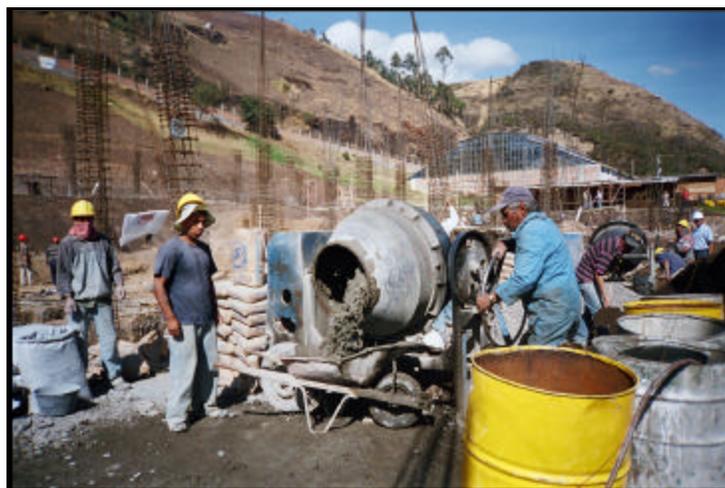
FUNDICION, VIBRADO Y TERMINADO DE VIGAS
